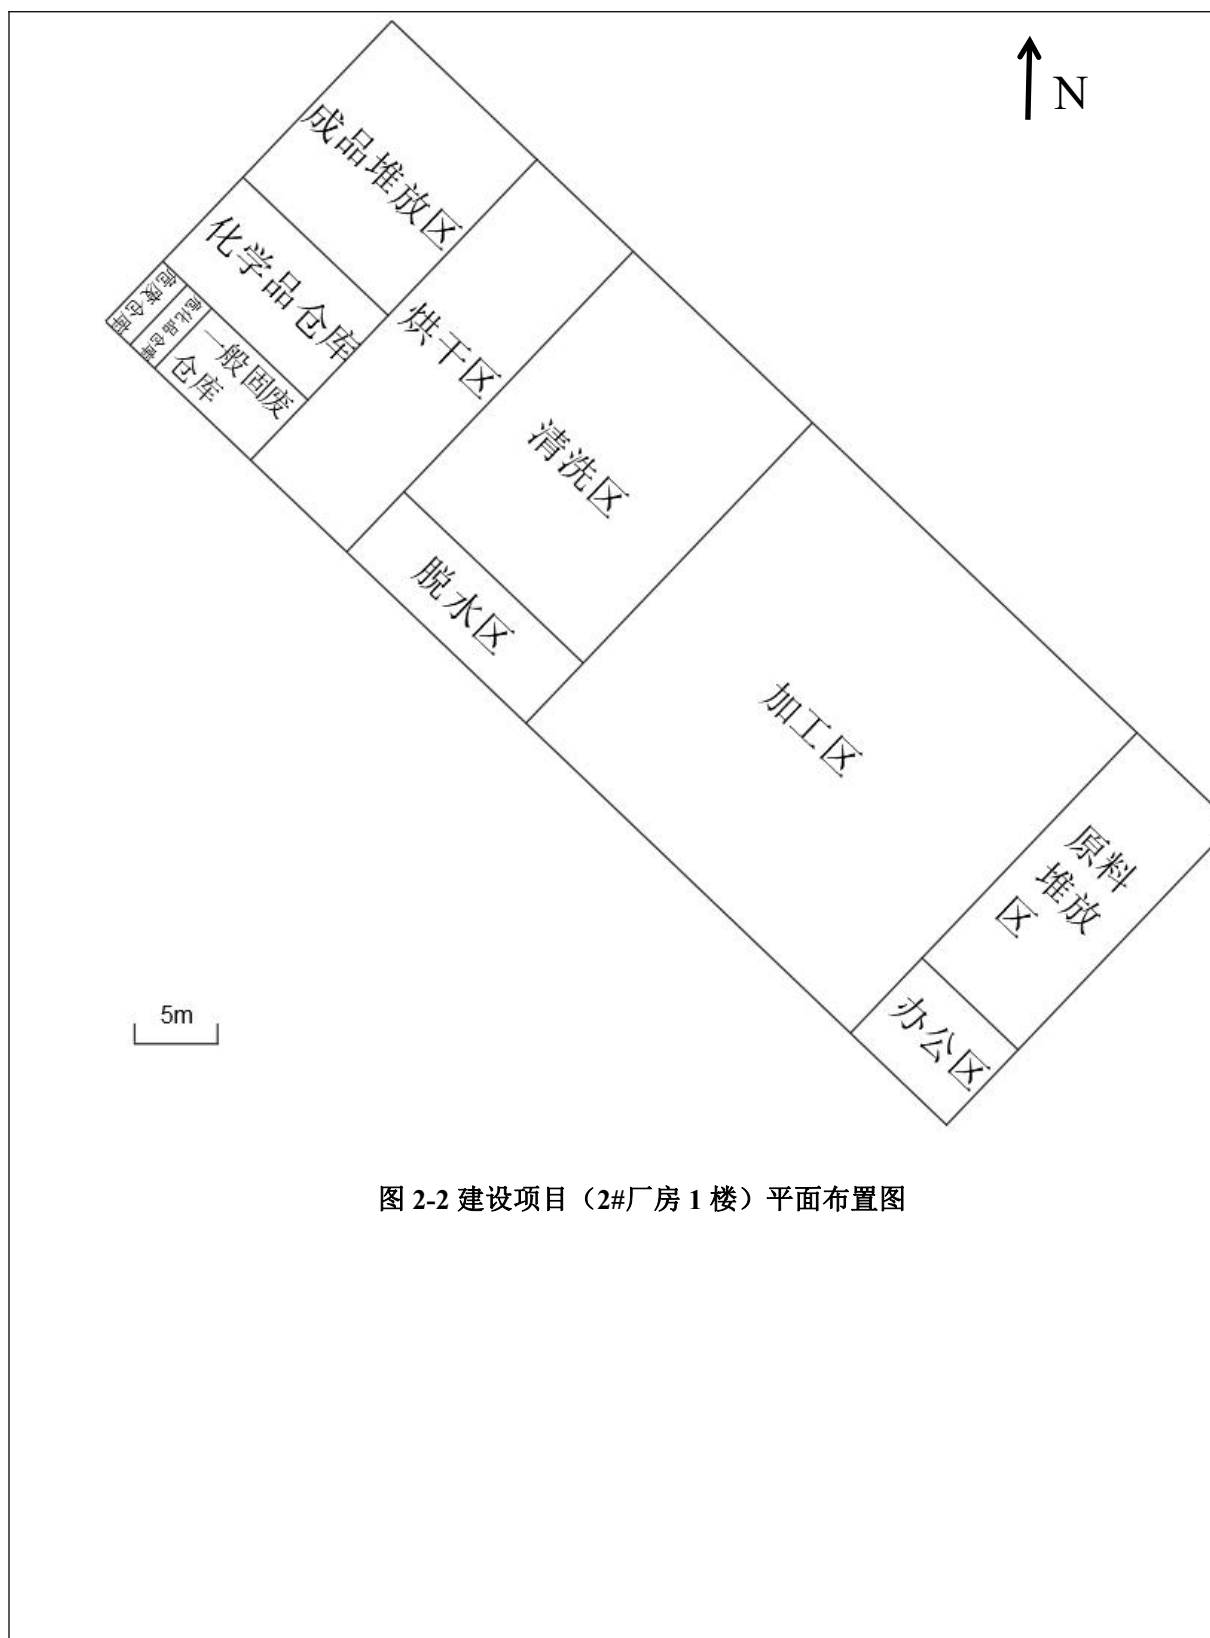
建设项目（2#厂房 1 楼）平面布置图
